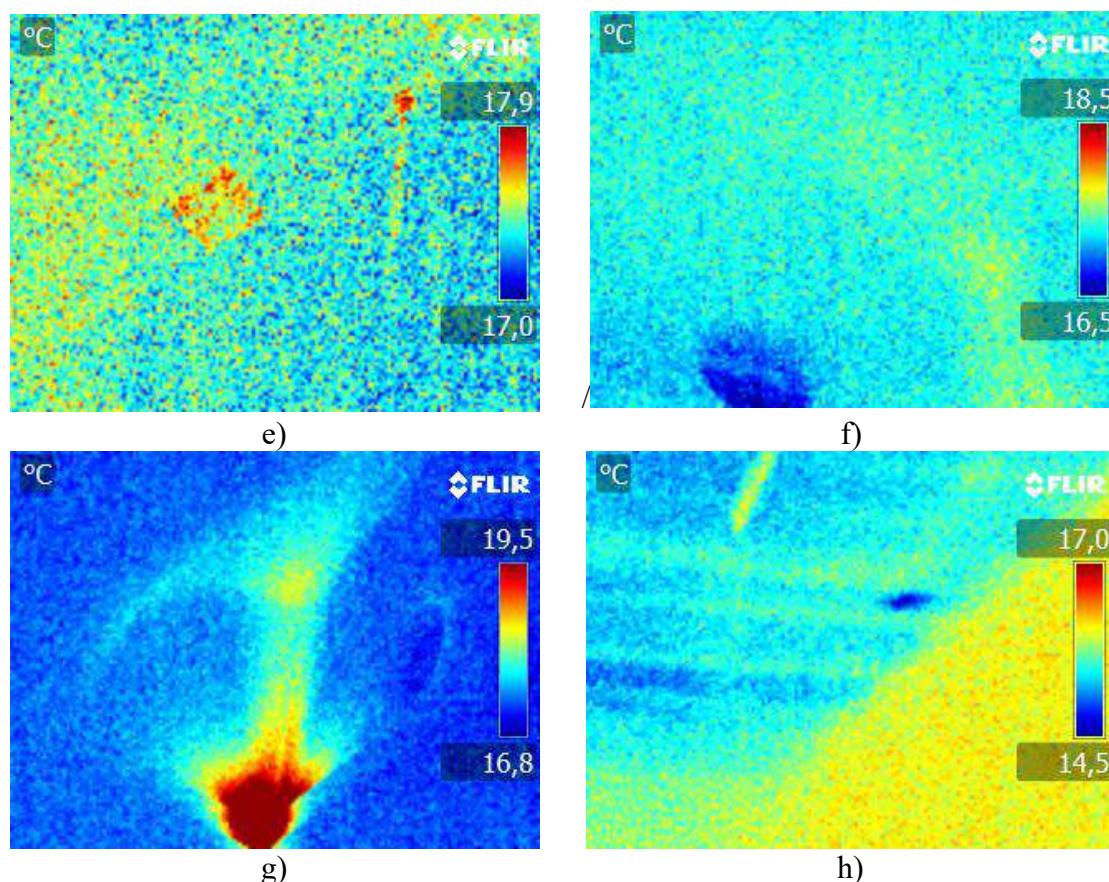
(Continuación). Termografía sala bajo cubierta 2: a) zona de ventana y forjado, b) Vista inferior de la cubierta, c) Vista conexión paramento lateral forjado, d) Vista conexión paramento lateral forjado, e) zona central de cubierta, f) Vista de muro divisorio trasero, g) Vista conexión paramento lateral y muro trasero, h) Gotera en zona de edificio anexo.
